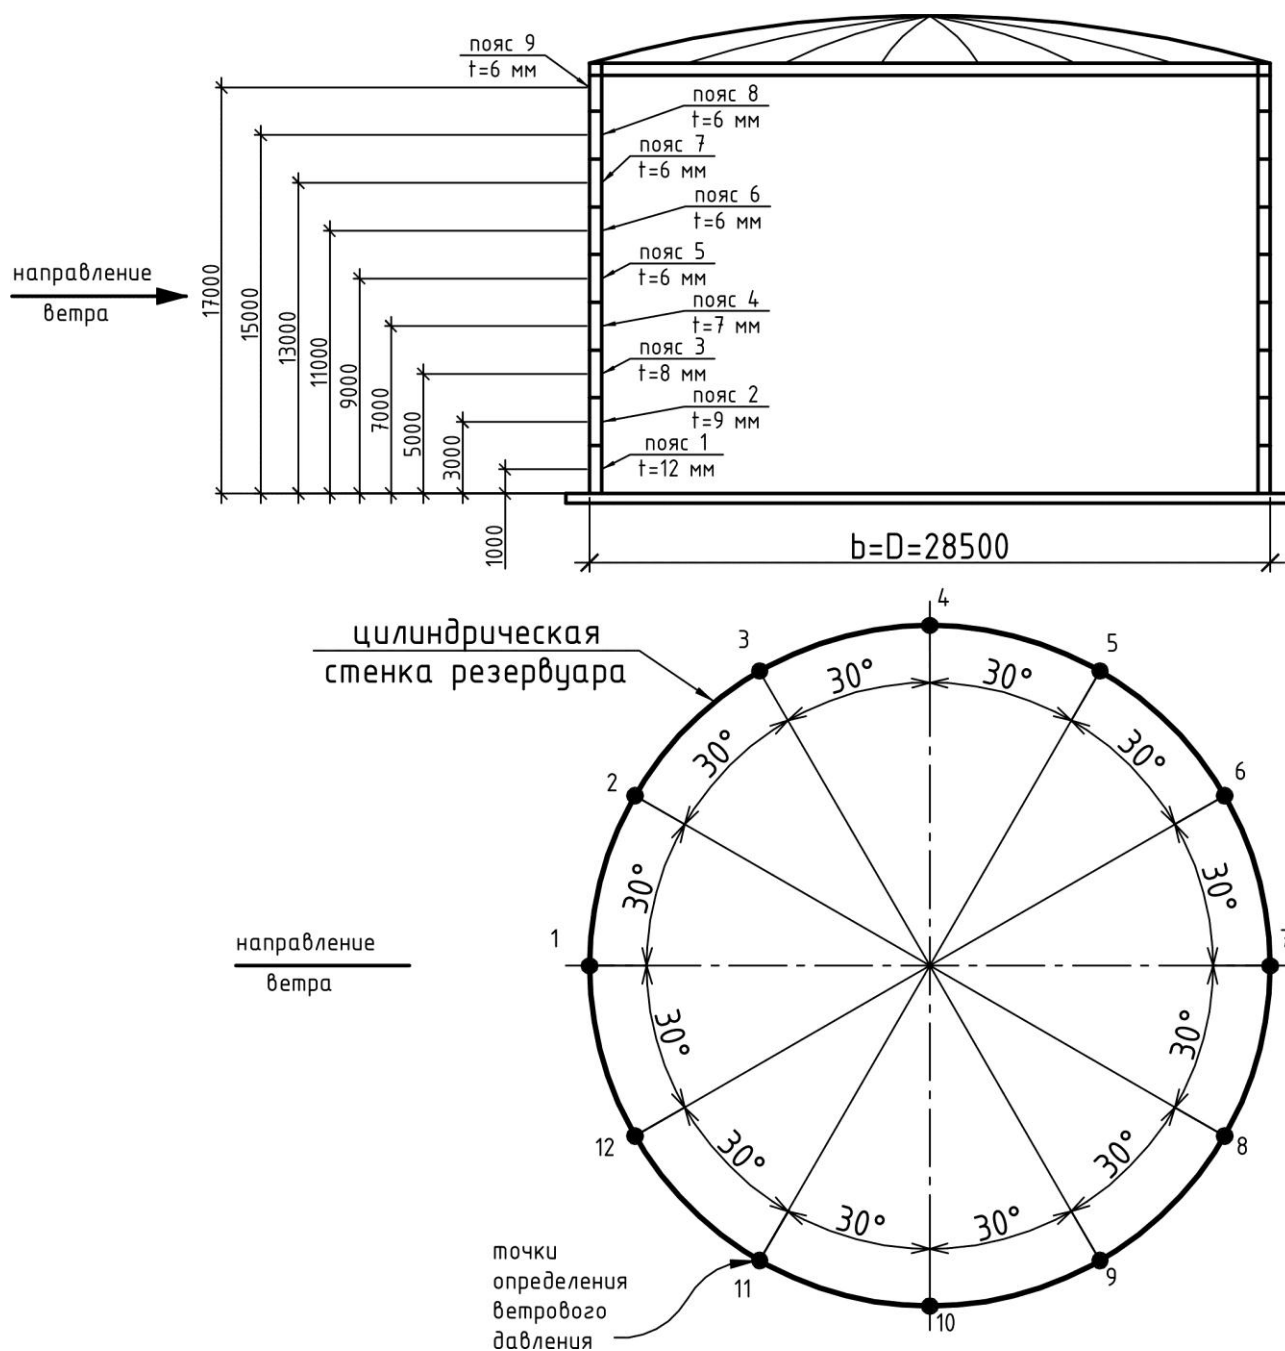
Схема резервуара для определения ветровой нагрузки
